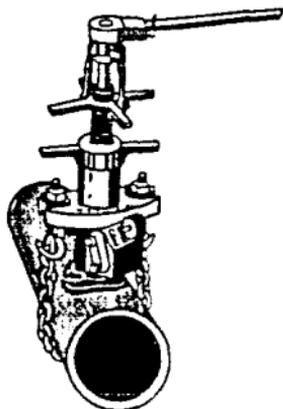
6. MAQUINA PERFORADORA Y MACHUELADORA (MUELLER)
